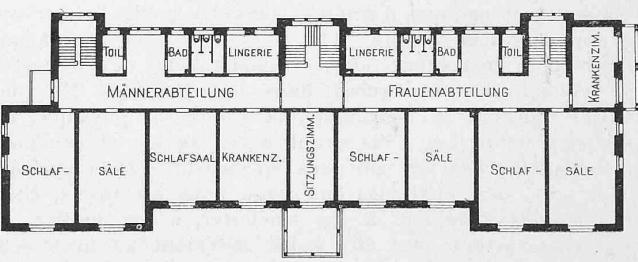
Grundriss vom ersten Obergeschoss.
